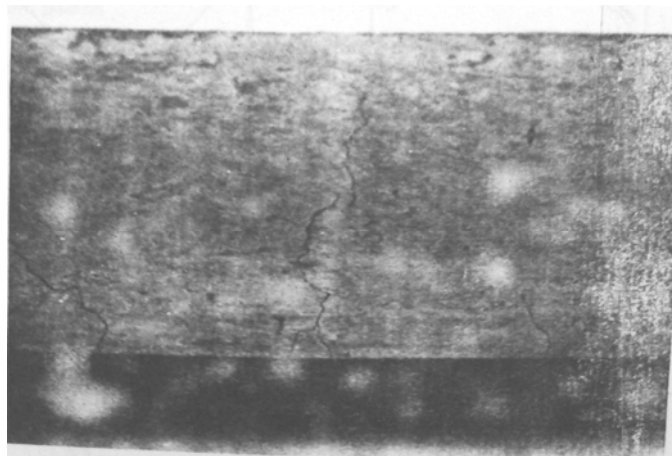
Ramificação das fissuras na base da viga, devida à presença das armaduras de tração. (Fonte: THOMAZ)
